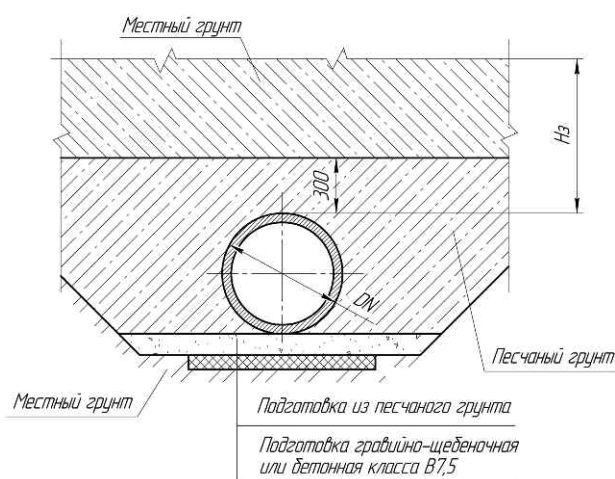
Укладка труб КОРСИС в водонасыщенных грунтах
